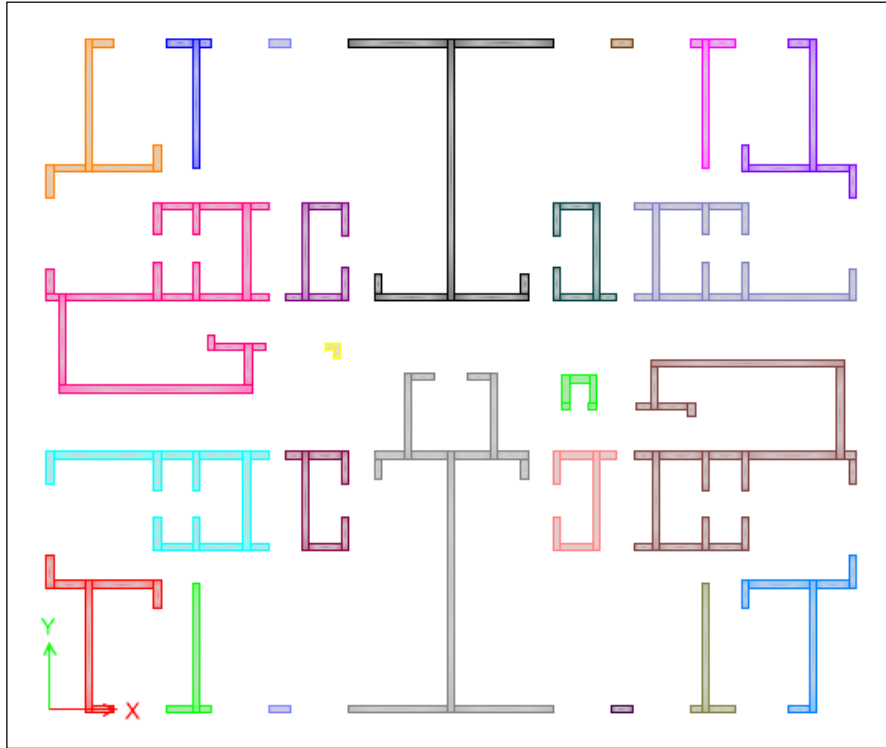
Vista en planta del Edificio K (elementos tipo barra de sección transversal irregular)
